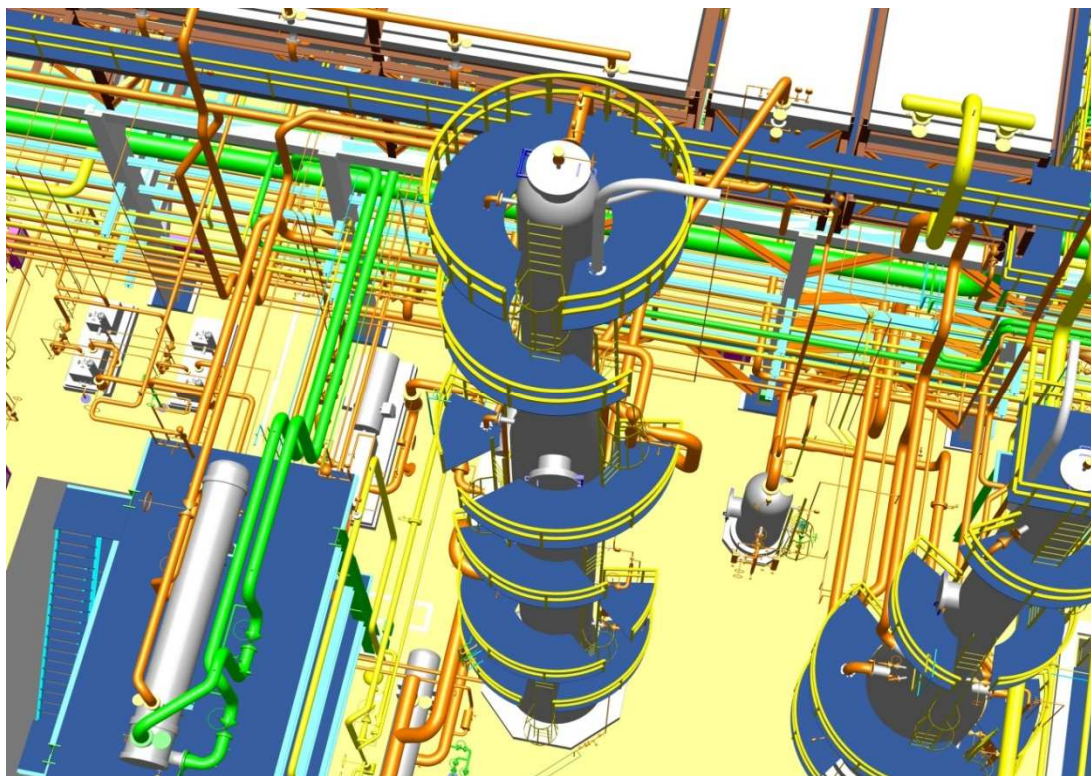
Disposición de Tuberías Alrededor de Torres- Plataformas
